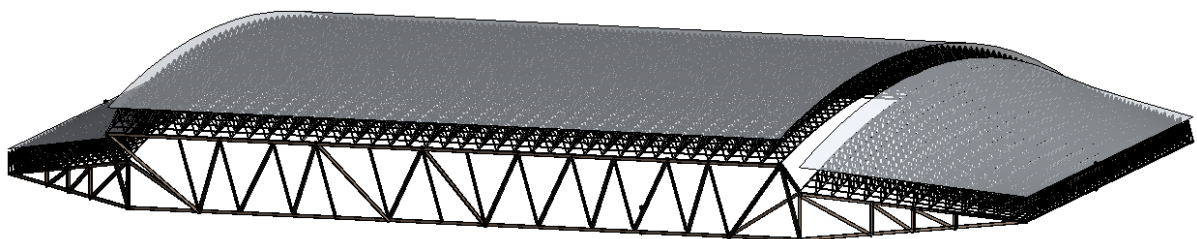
Vista frontal del techo del estadio. Fuente: elaboración propia.
